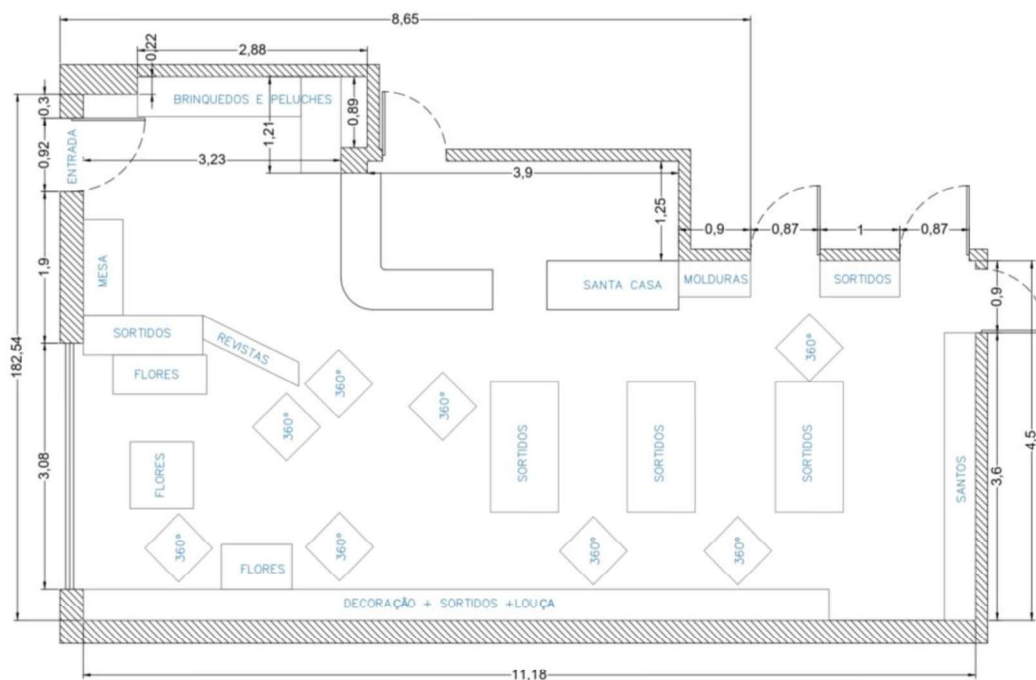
Planta de levantamento e organização espacial existente. Fonte: Autor
